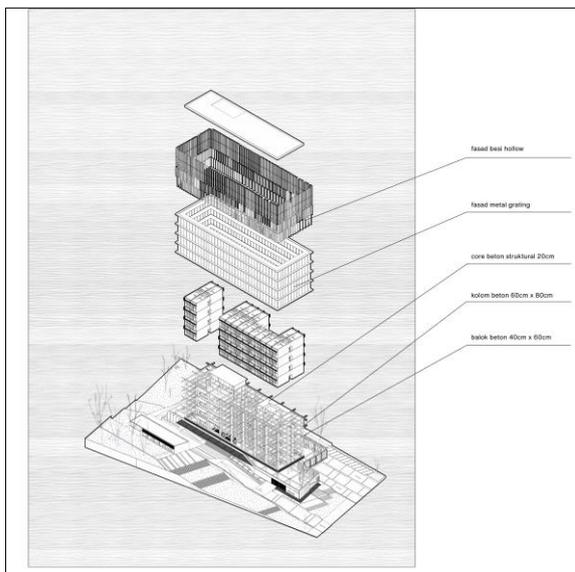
Sistem struktur rangka konstruksi beton dan fasad
